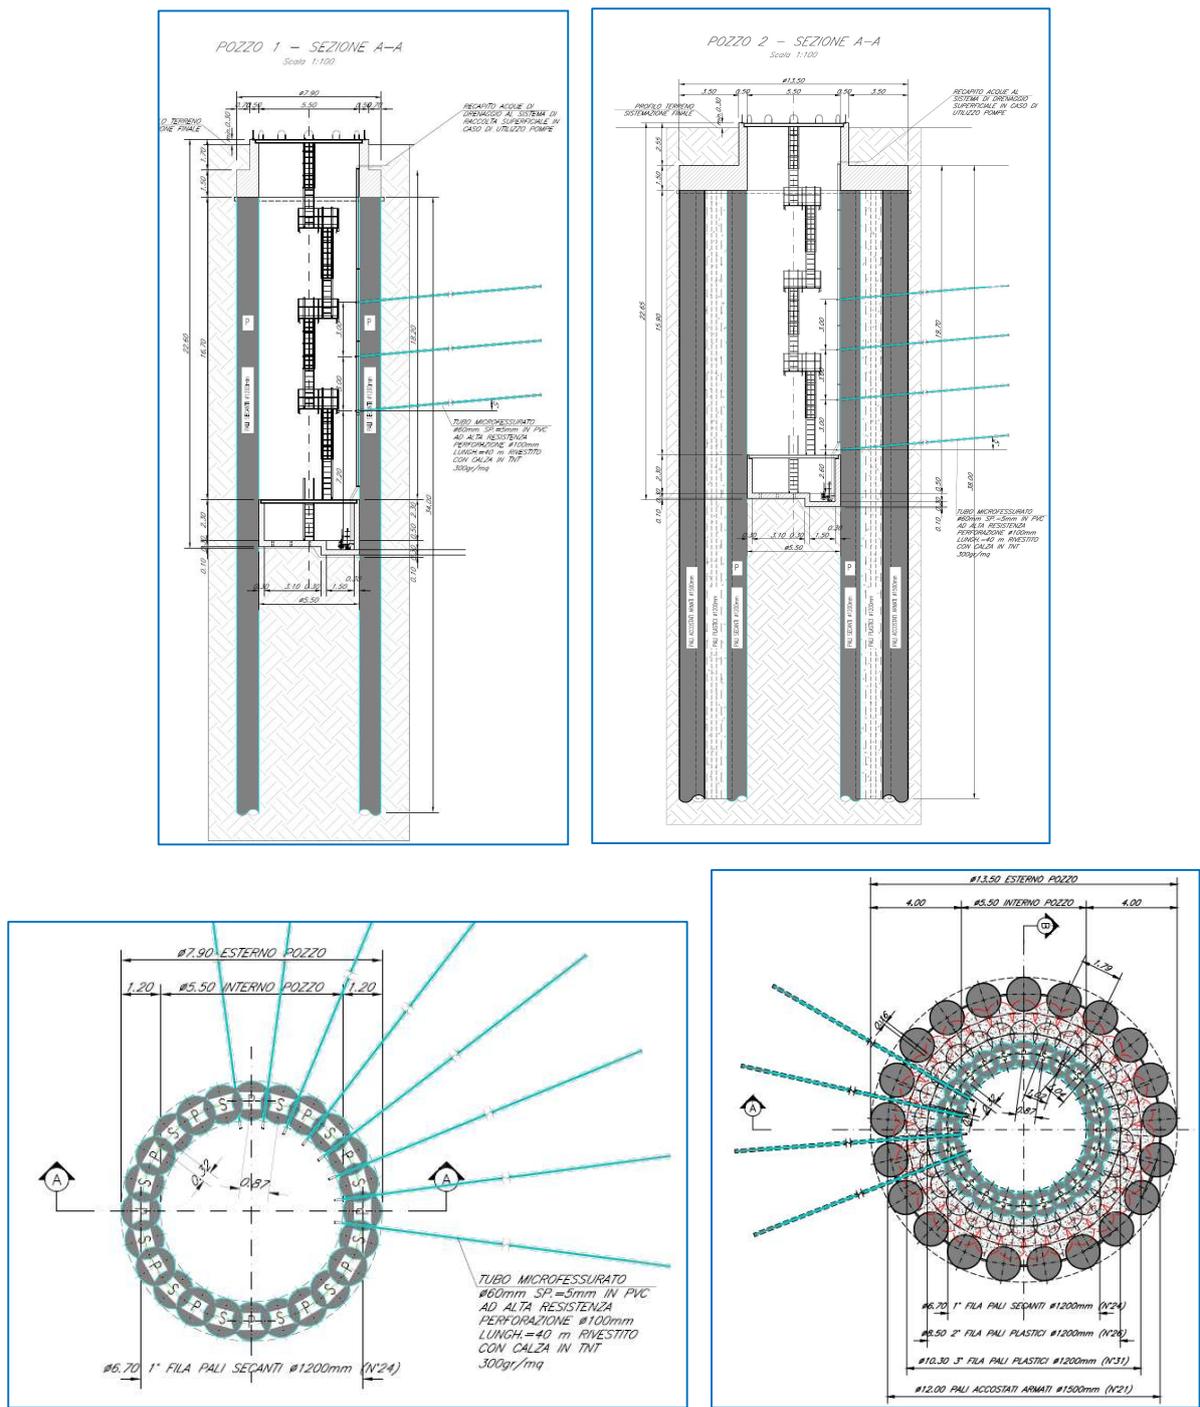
Layout Pozzi di Drenaggio PZ1 e PZ4 a sinistra, PZ2 e PZ3 a destra
